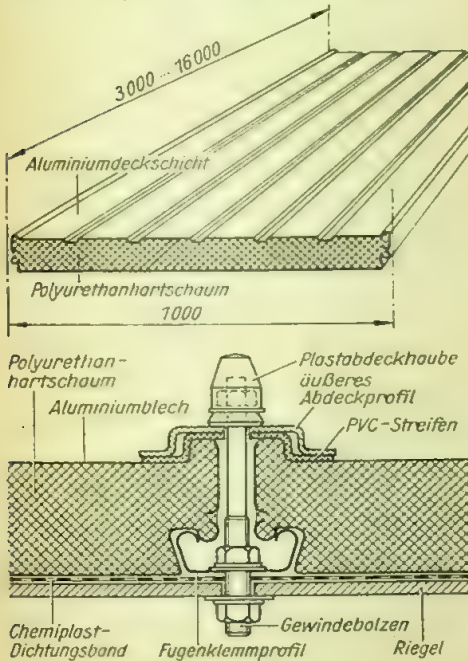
Dachdeckung (ähnlich Außenwand) Stützkernelement Al-Pur-Al, unten Fugendichtung
